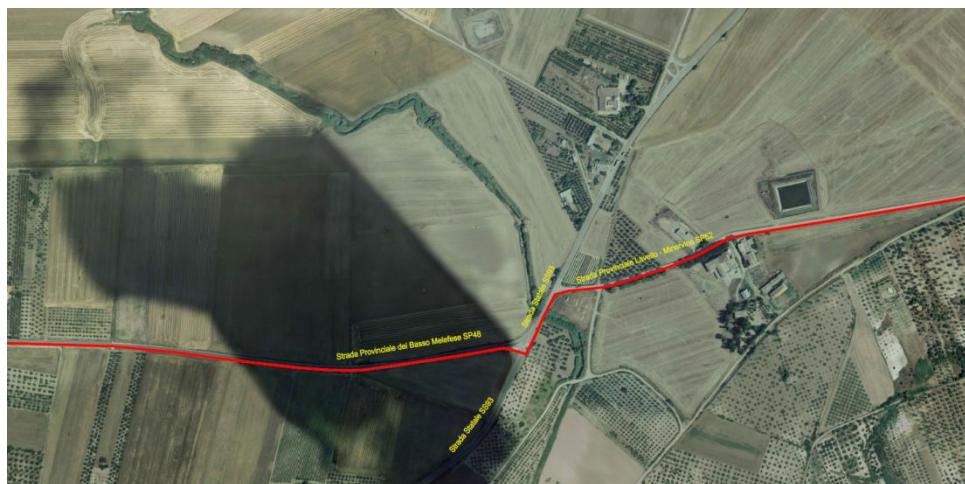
Stralcio planimetrico su Ortofoto con indicazione dell'interferenza n. 3 con il torrente Olivento
